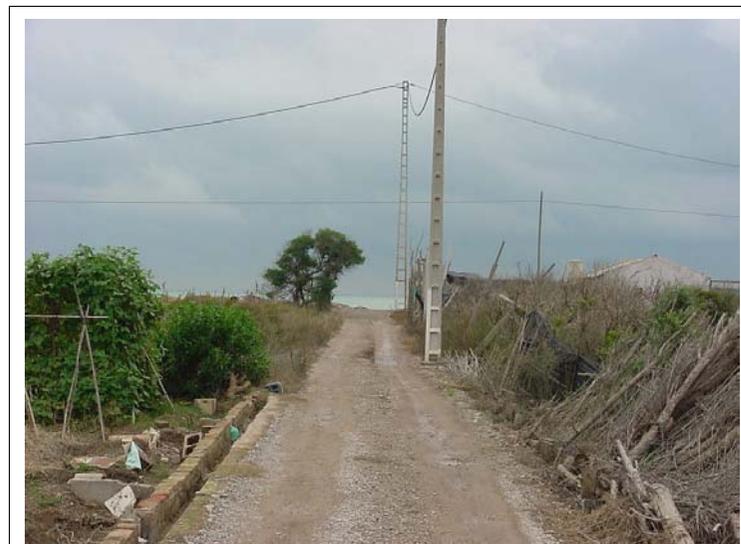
Camino en tierra de 3 m de ancho. Postes de línea de baja tensión.
